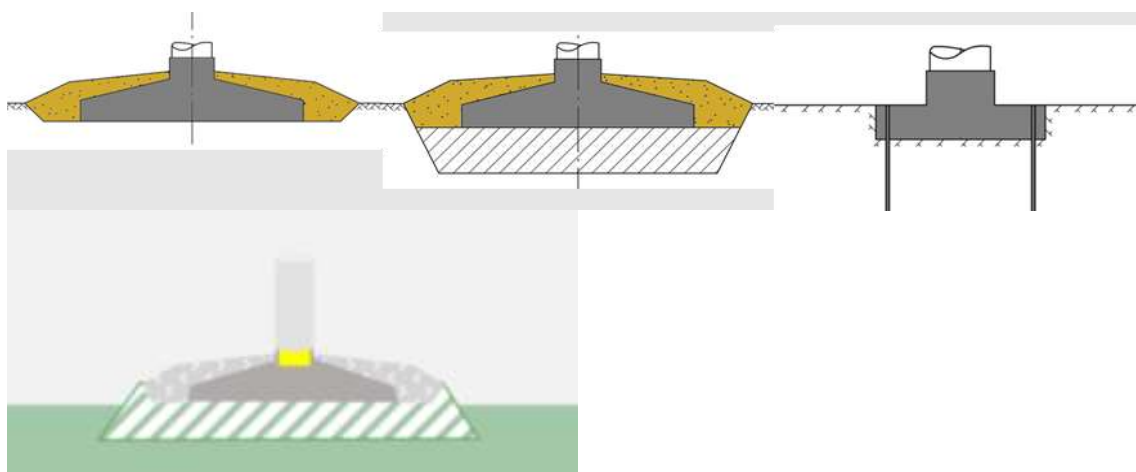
Principbilder över en grund av armerad betong på mark (till vänster) eller på en grund av armerad betong med massabyte (i mitten) samt en bergsförankrad grund av armerad betong (till höger). Nedan visas en grund i armerad betong på upphöjd mark som används av ABO Energy Suomi Oy.
